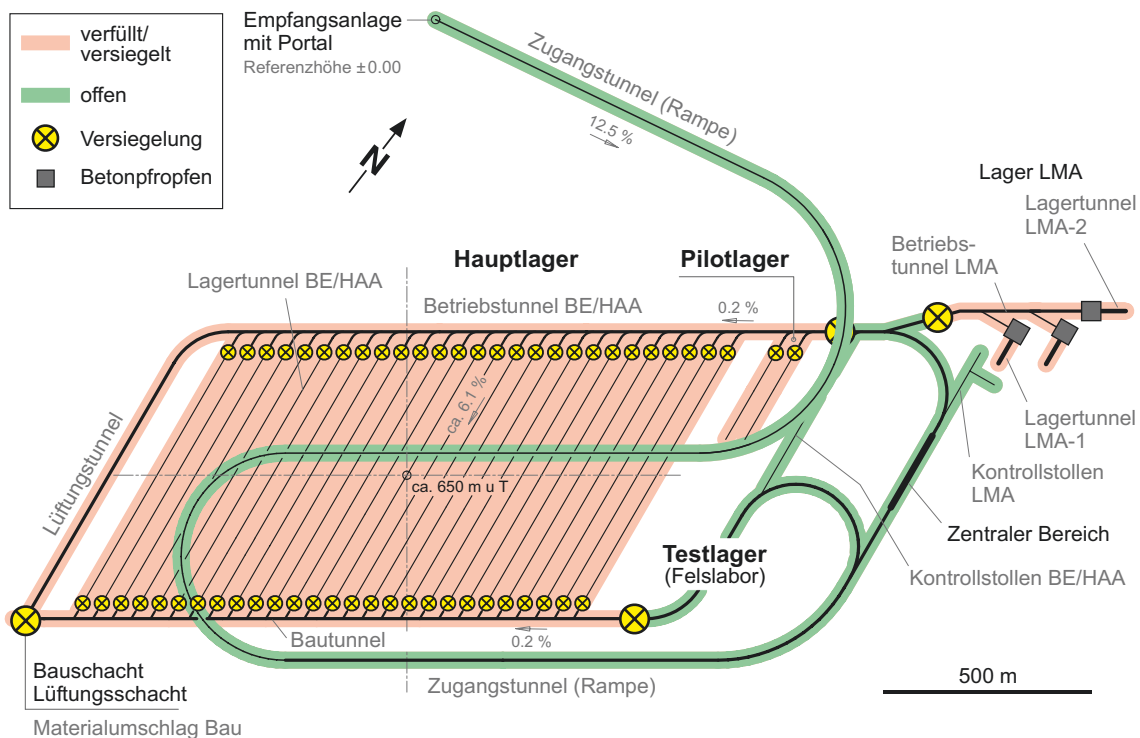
Situation nach dem Verschluss des Hauptlagers
